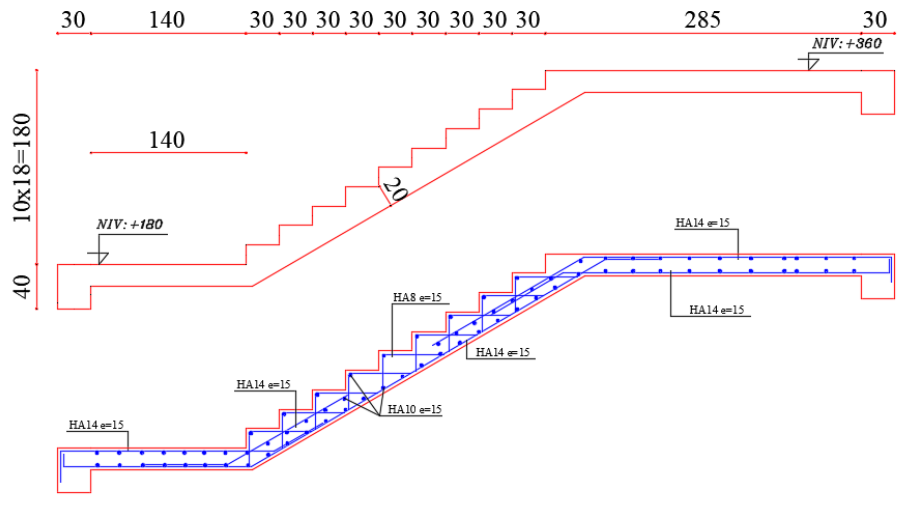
Schéma de ferrailage des escaliers coupe 2-2
